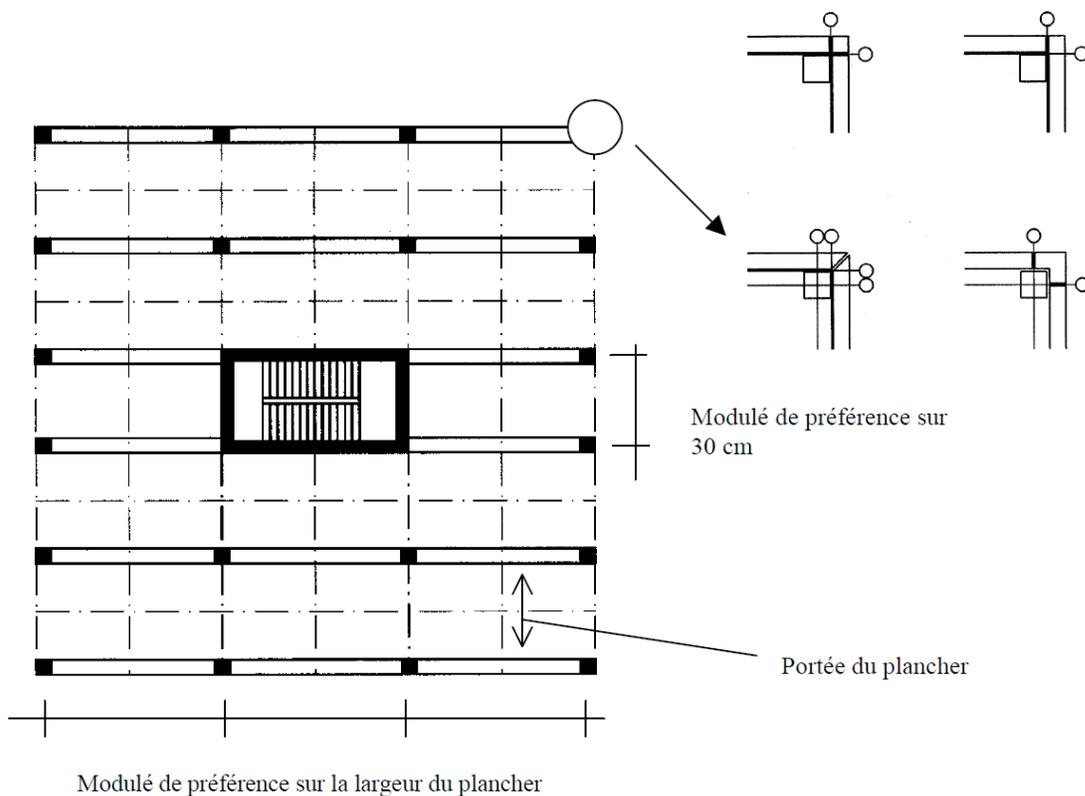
Exemple de système modulaire pour les constructions préfabriquées
